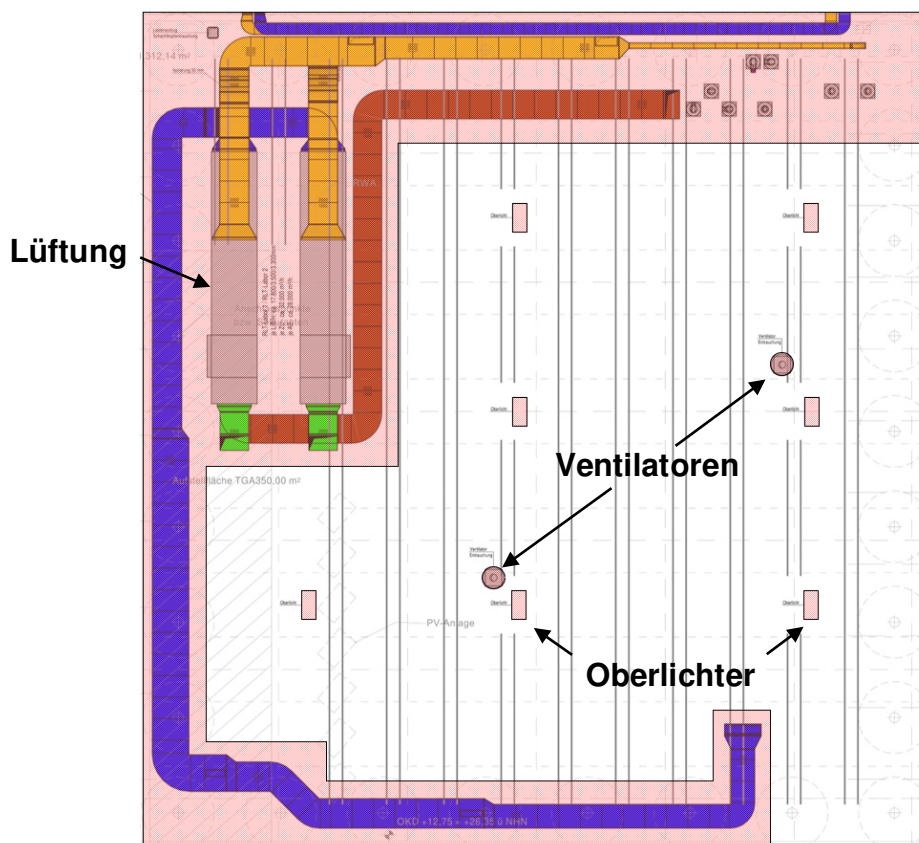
Grundrissausschnitt mit besetzten Flächen (eigene Darstellung)
